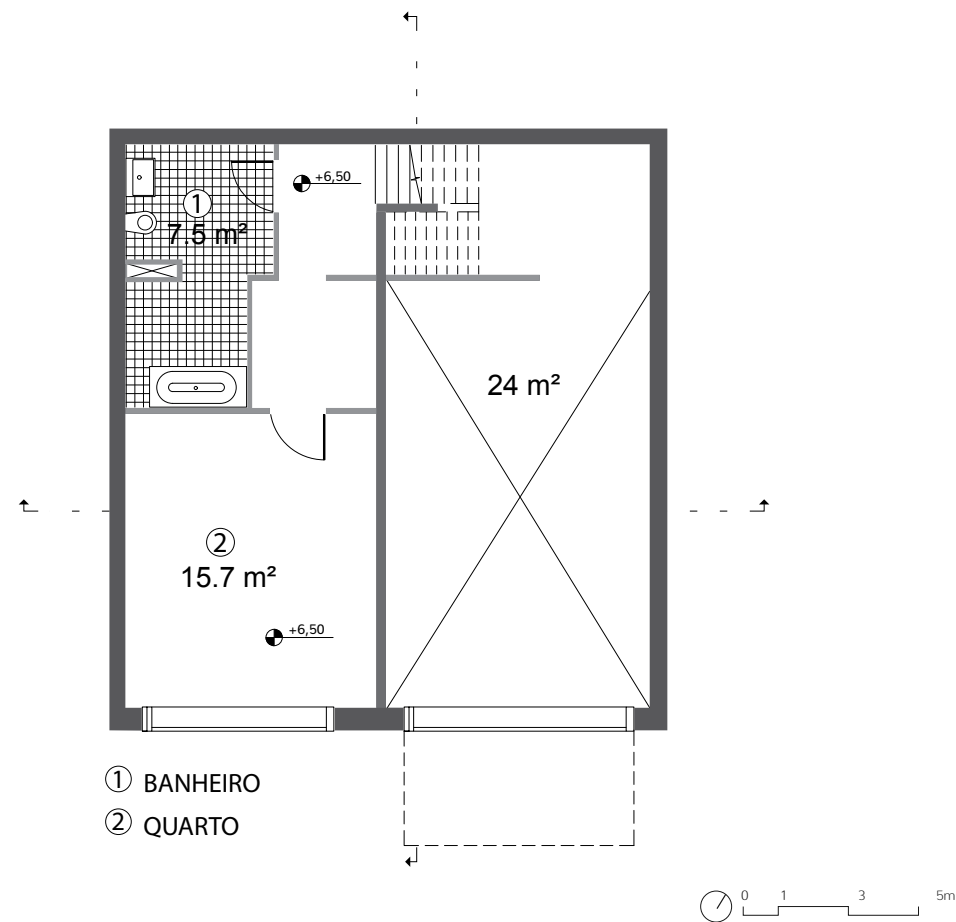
Planta baixa segundo pavimento - *Gardenhouse*.
